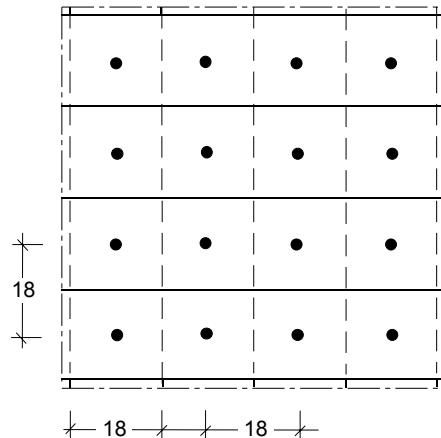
Angenommenes Nagelbild bezüglich der Vernagelung der einzelnen Lagen. Darstellung als Ausschnitt im Grundriss.
